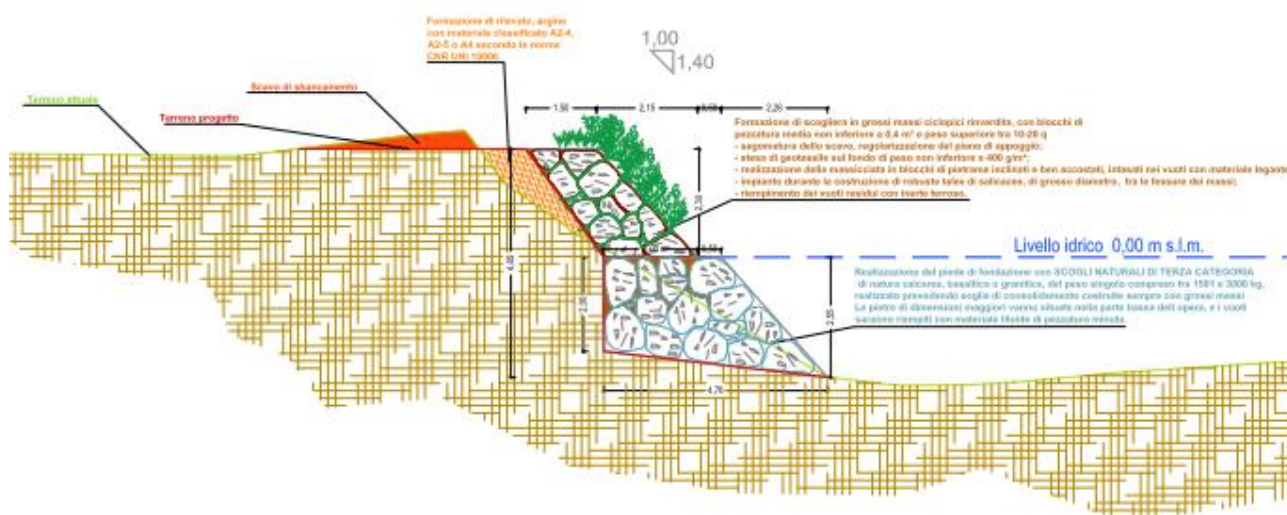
Sezione caratteristica di progetto del tratto oggetto d'intervento.
